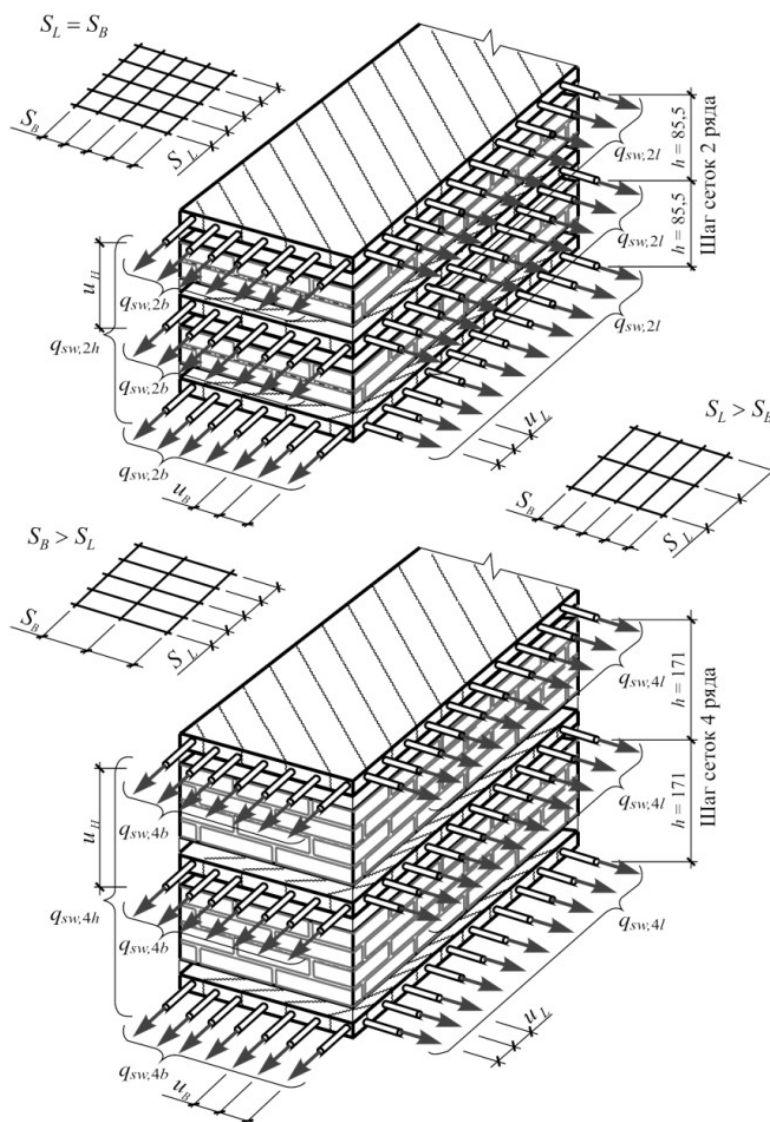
Схемы армирования, характер распределения усилий в арматурных стержнях и виды сеток для армирования стен
